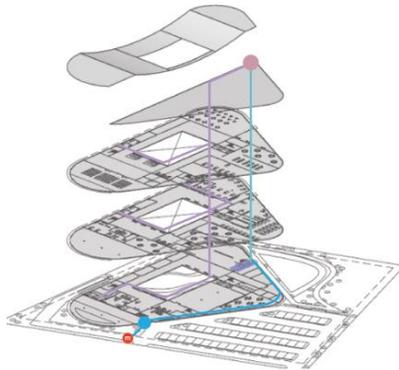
Penyaluran beban sistem struktur *space truss* dan rangka
